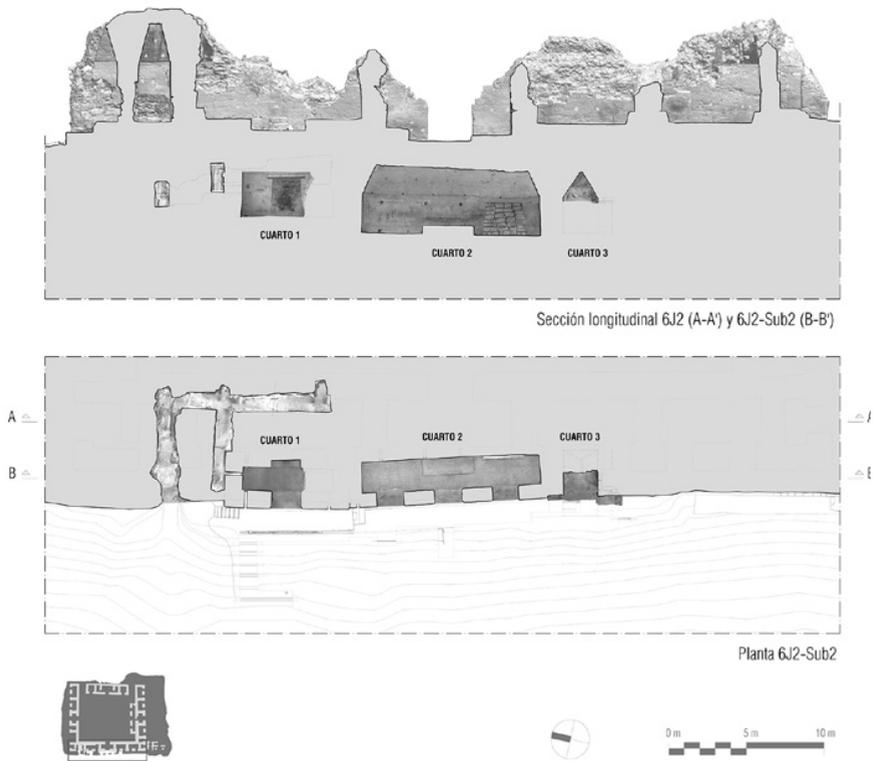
Planta de la subestructura 6J2-Sub2 y sección longitudinal compuesta de la subestructura y el ala oeste del edificio 6J2. Elaboración propia a partir del levantamiento del PLB.
